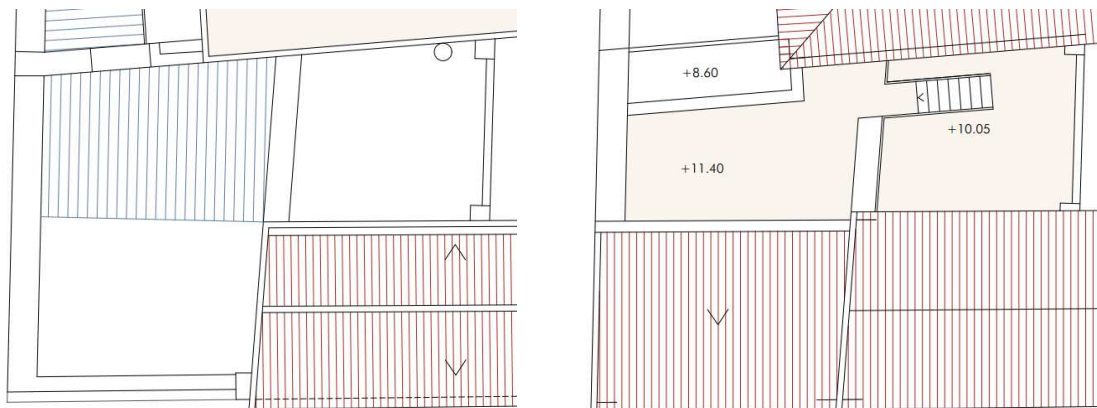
Planta de cubiertas. Estado previo (izquierda) y estado reformado (derecha)
